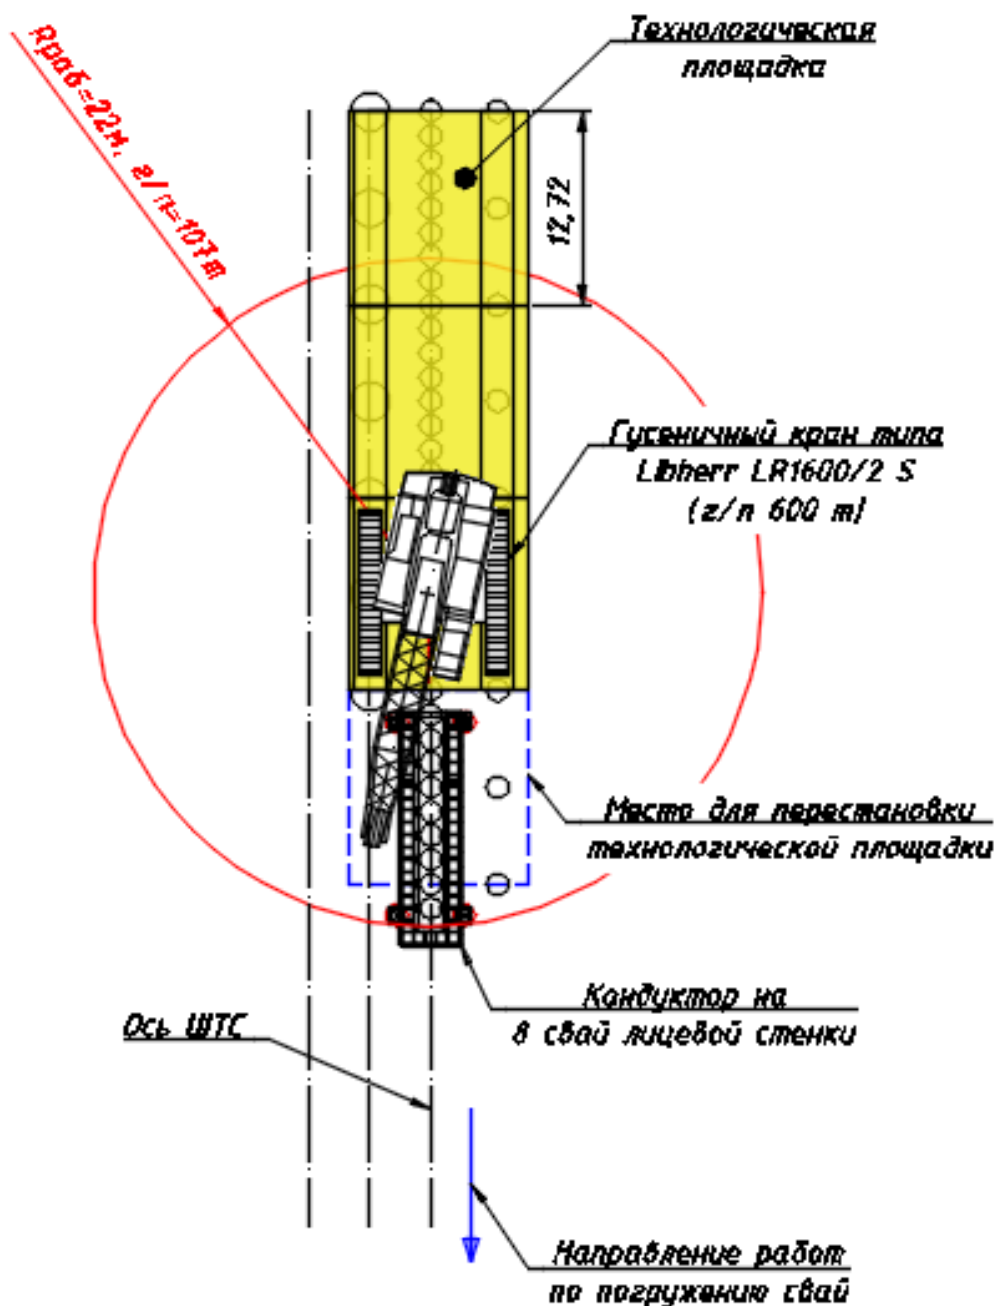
схема погружения ШТС и свай экранирующего ряда с техплощадки
